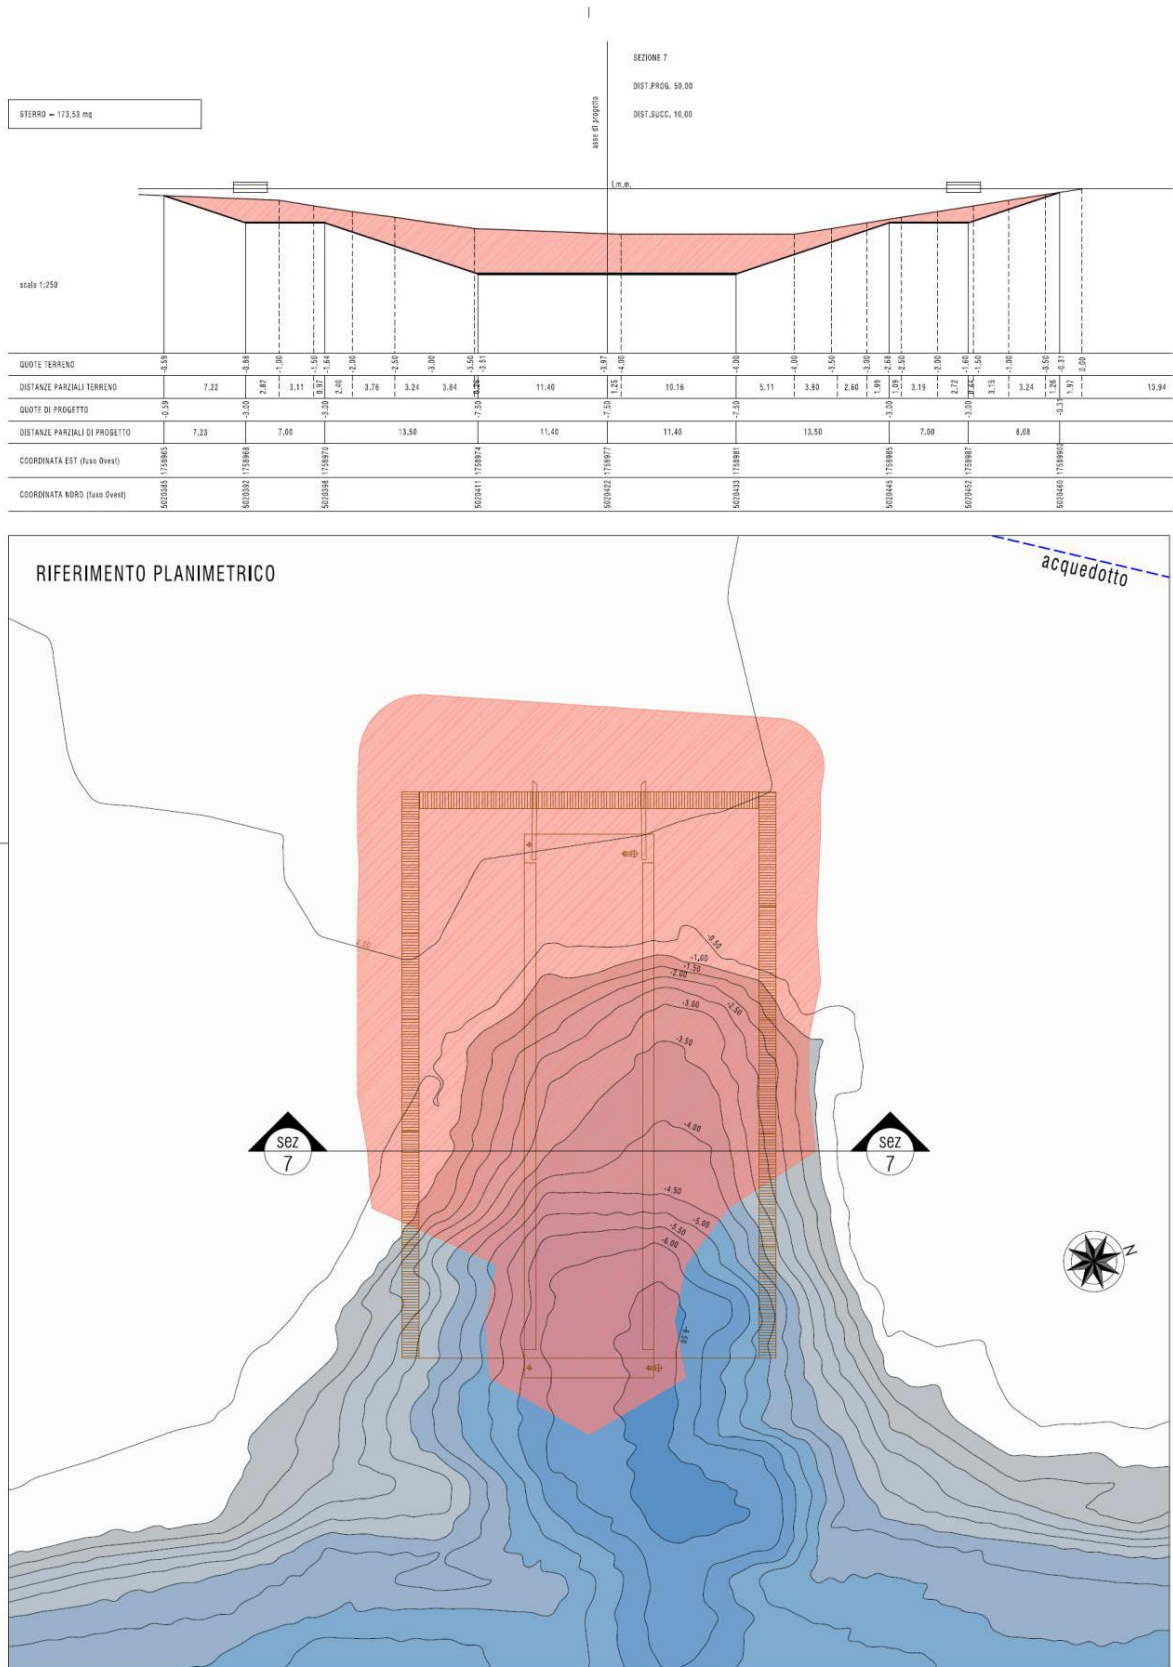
Estratto planimetria degli sterri e sezione trasversale di scavo dell'intervento "Adeguamento degli spazi acquei esistenti degli ex Cantieri De Poli"
